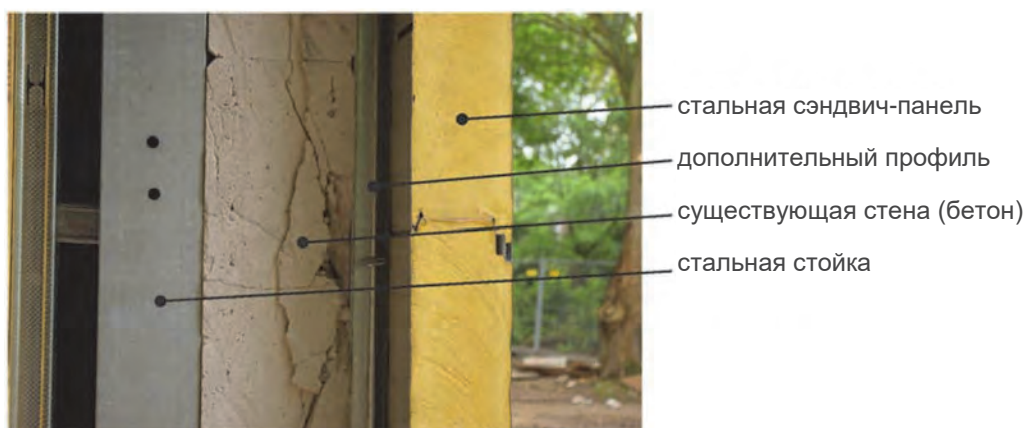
Бетонная стена, облицованная при реконструкции стальными сэндвич-панелями
